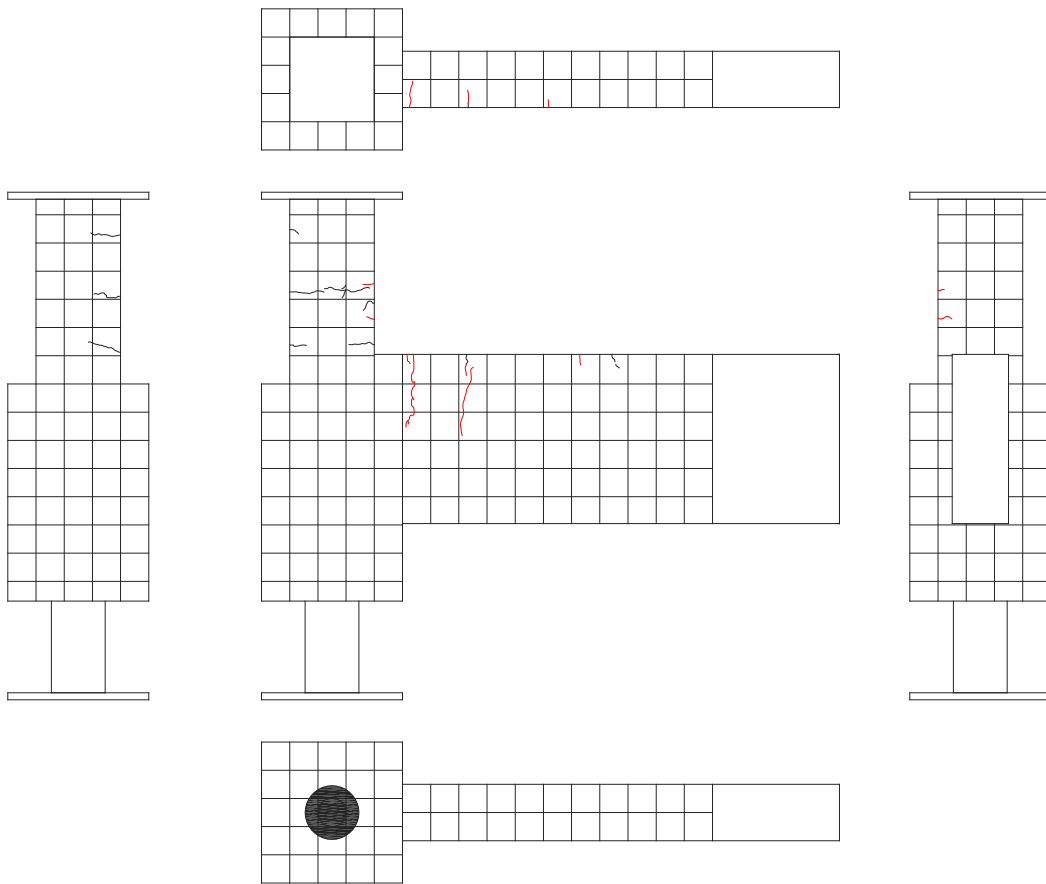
3. 122 試験体 A-5 ひび割れ状況 (10Cycle)
